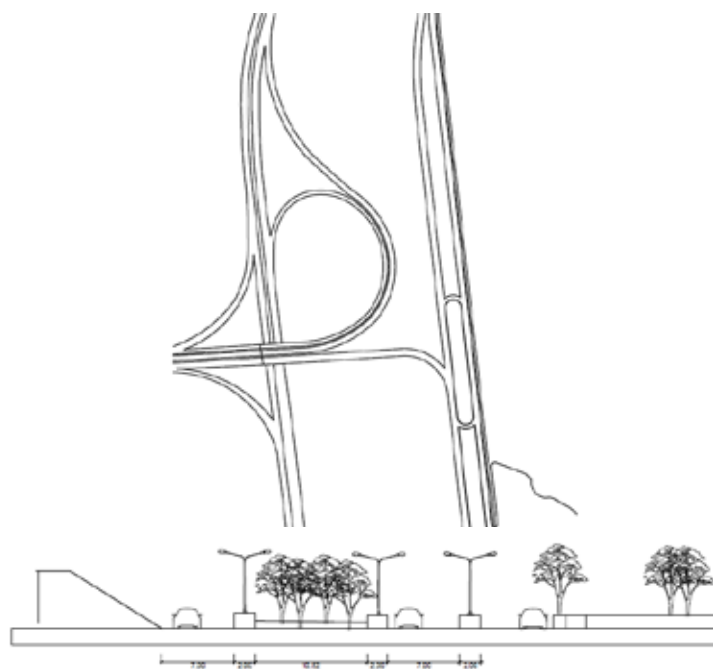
Perfil Vial de la Avenida Alejandro Zuluaga. (2018).
